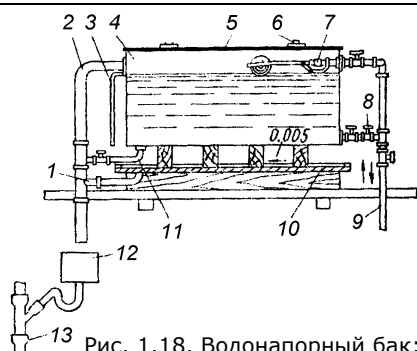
Водонапорный бак: 1 - сливная труба; 2 - переливной трубопровод; 3 - сигнальный трубопровод; 4 - бак; 5 - крышка; 6 - люк; 7 - поплавковый клапан; 8 - обратный клапан; 9 - подающая и расходная трубы; 10 - поддон; 11 - спускная труба; 12 - промежуточный бачок; 13 - стояк
